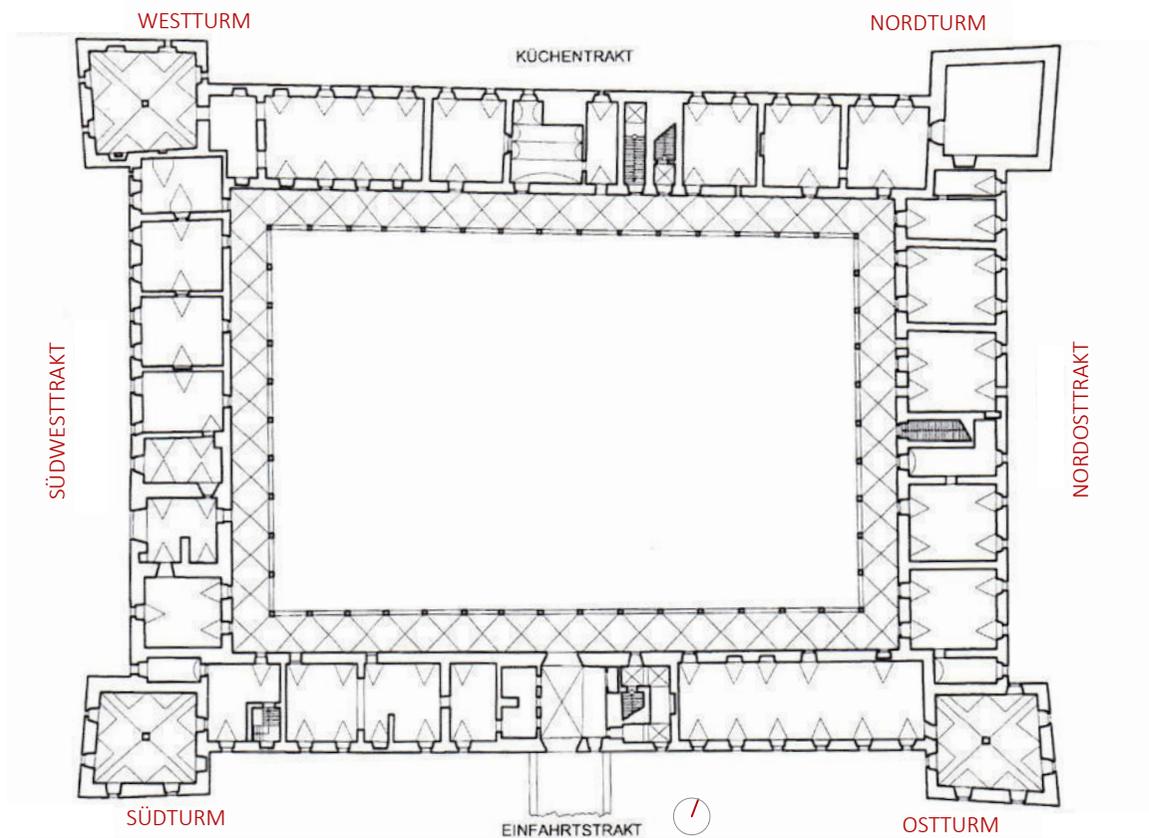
Plan Erdgeschoss Schloss Deutschkreutz (ab 1966)
